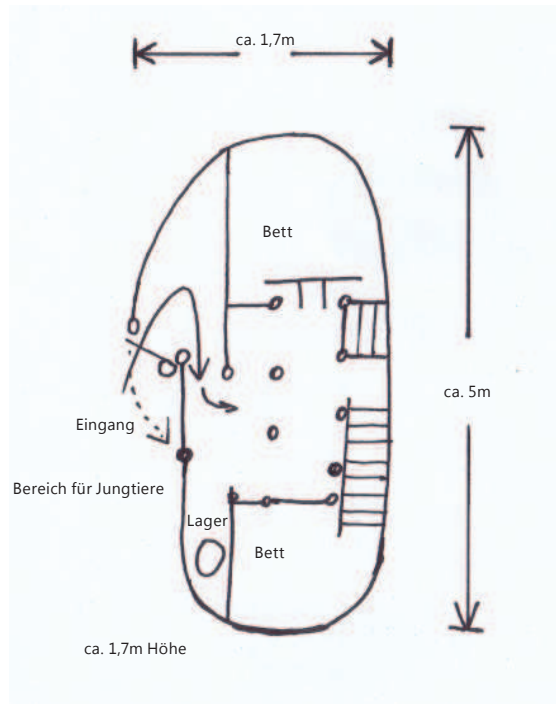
Grundriss mit Raumaufteilung einer typischen Massai-Hütte (nach Tychsen)
